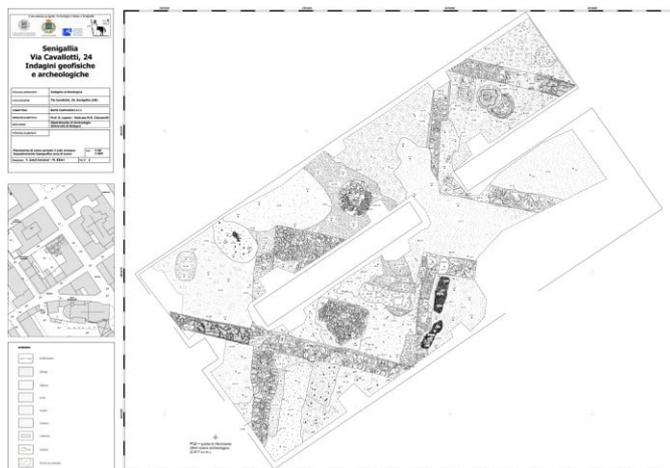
Planimetria generale dell'area di scavo (elaborazione Tommaso Casci Ceccacci, Michele Silani).
